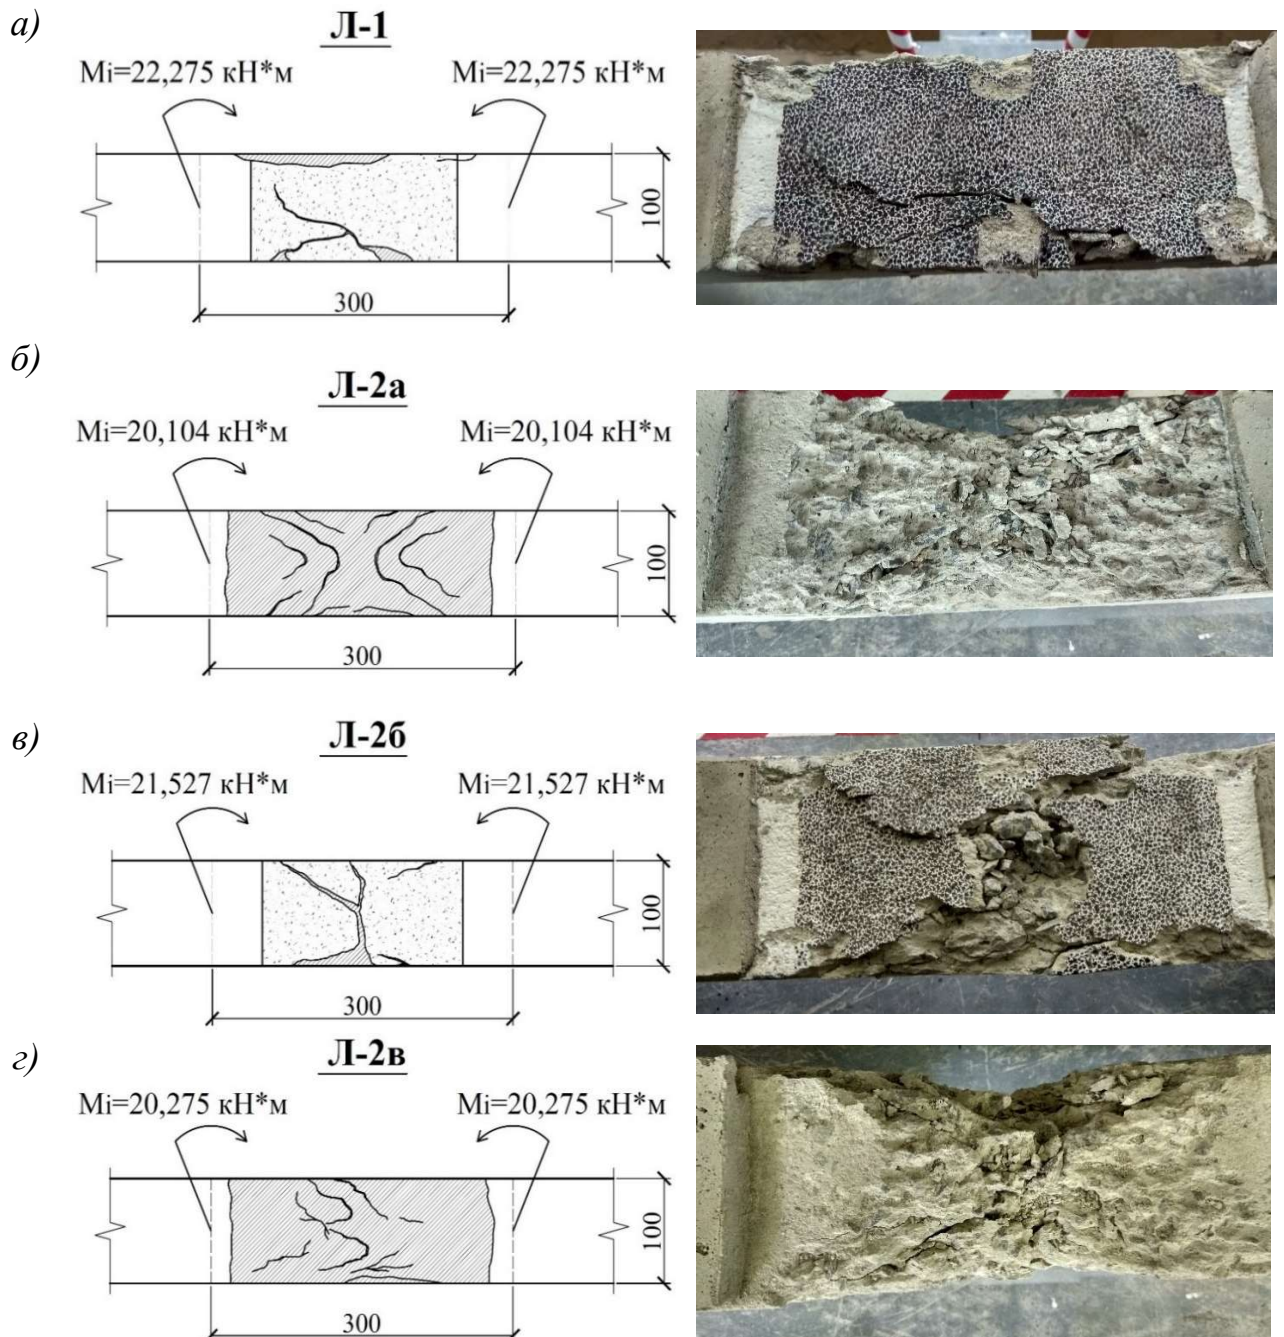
Руйнування стиснутої зони бетону лінійних балок: а – балки Л-1; б – балки Л-2а; в – балки Л-2б; г – балки Л-2в
